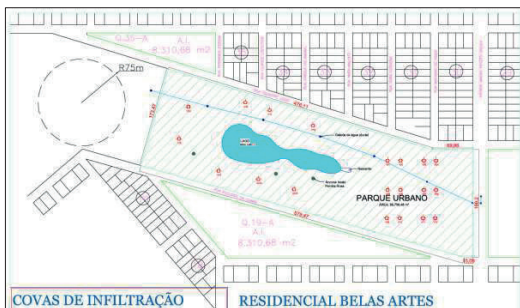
Localização do lago artificial projetado. Fonte: Estudo de Caracterização Hidrológica "Belas Artes".
